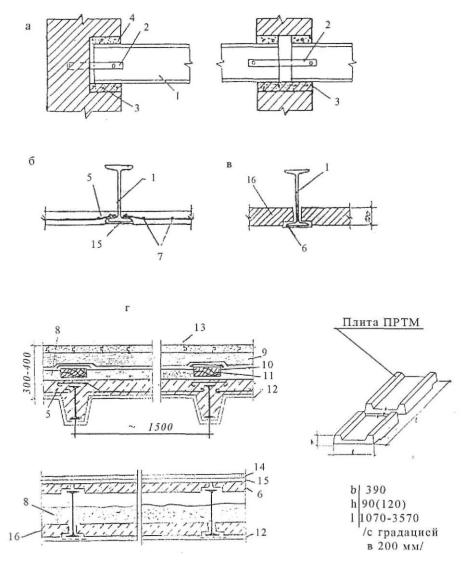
Сборные железобетонные балочные перекрытия: а- общий вид; б - легкобетонная плита; в - легкобетоиный камень вкладыш; г, д - варианты решений перекрытия;
